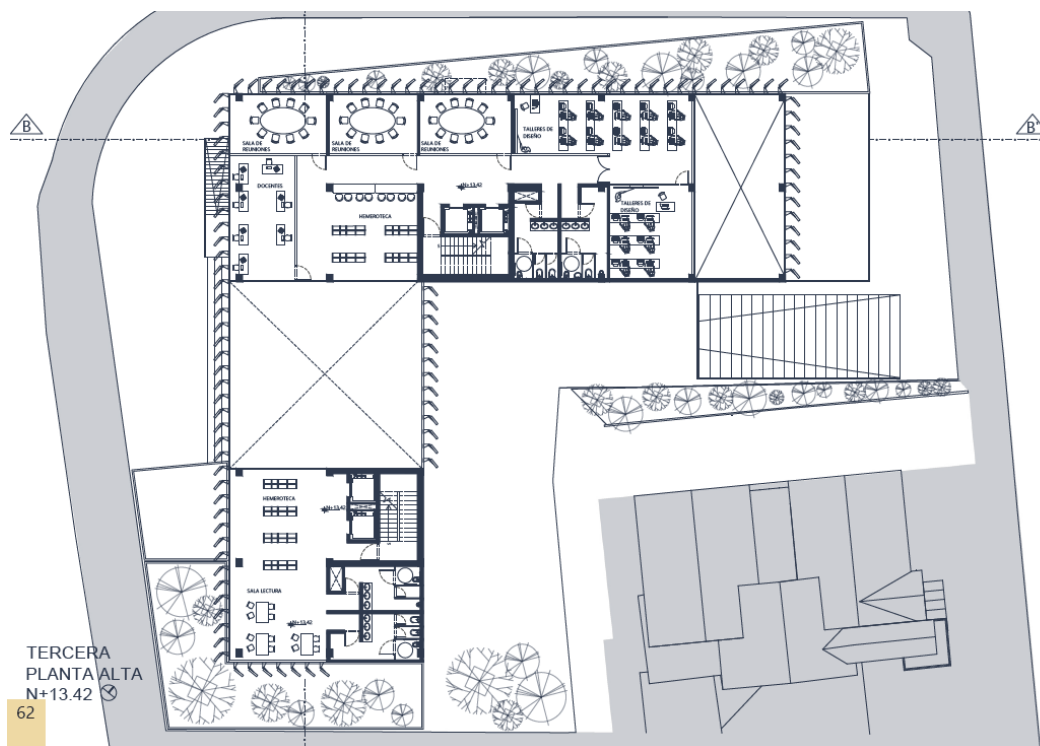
Tercera Planta Alta N+13.42. Autoría propia
